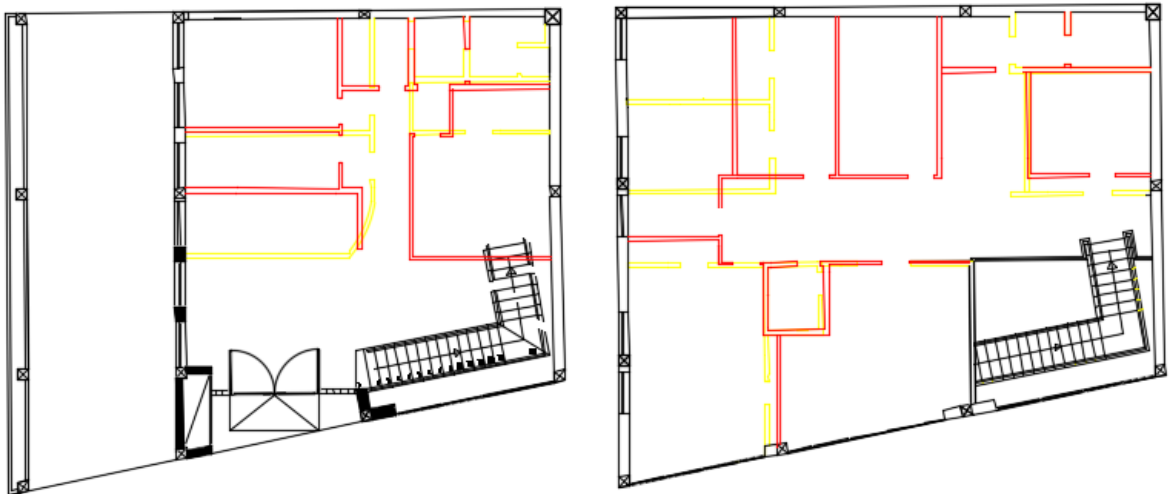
Plantas de alterações, em Autocad. Fonte: Ana Cândido.
